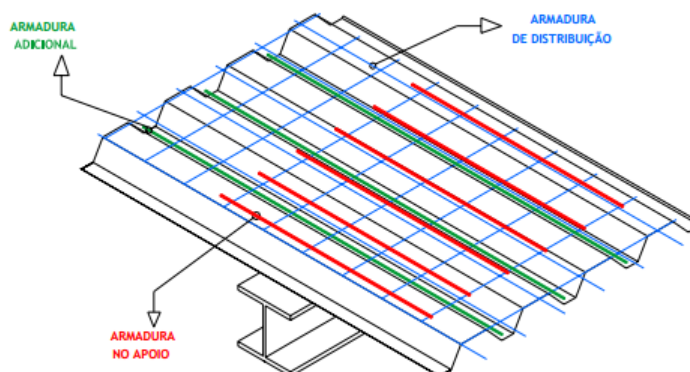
Pormenor da disposição de armaduras (estrutura da laje apoiada sobre vigamentos metálicos), (Fonte: COLABORANTE – Perfilagem de chapa, Lda, [41])
